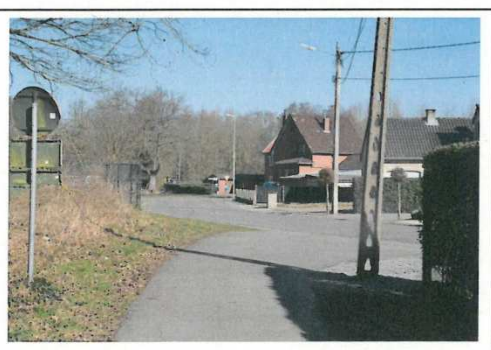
Overgang Munsterbeekweg Kuilenweg
